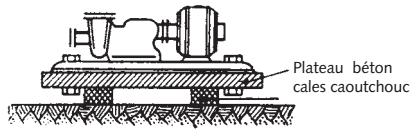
Montage d'un groupe électropompe sur cales caoutchouc
